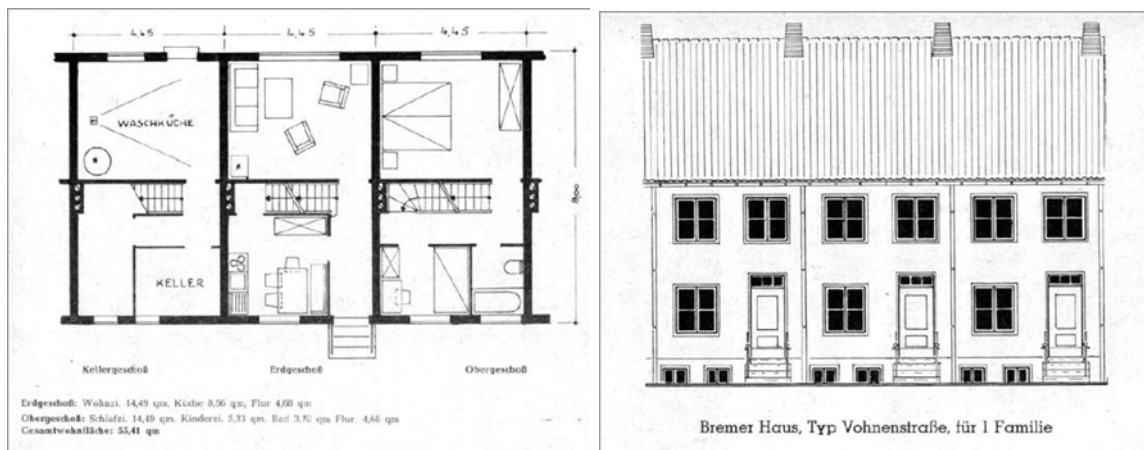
Grundrisse und Ansicht der „neuen“ Bremer Häuser (Kummer, 1953)
